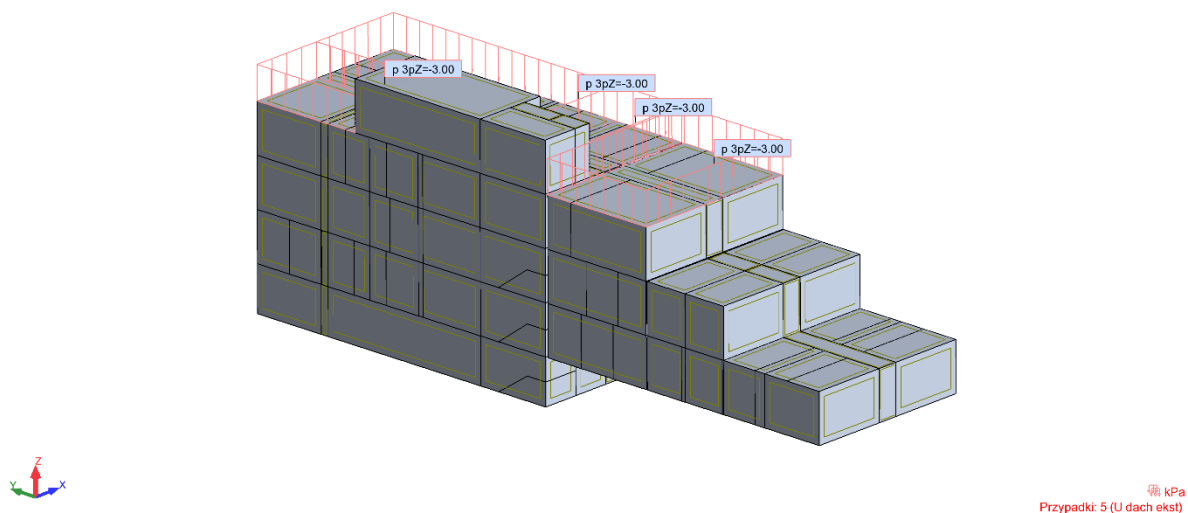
Przypadek obciążenia stałego od dachu intensywnego.
